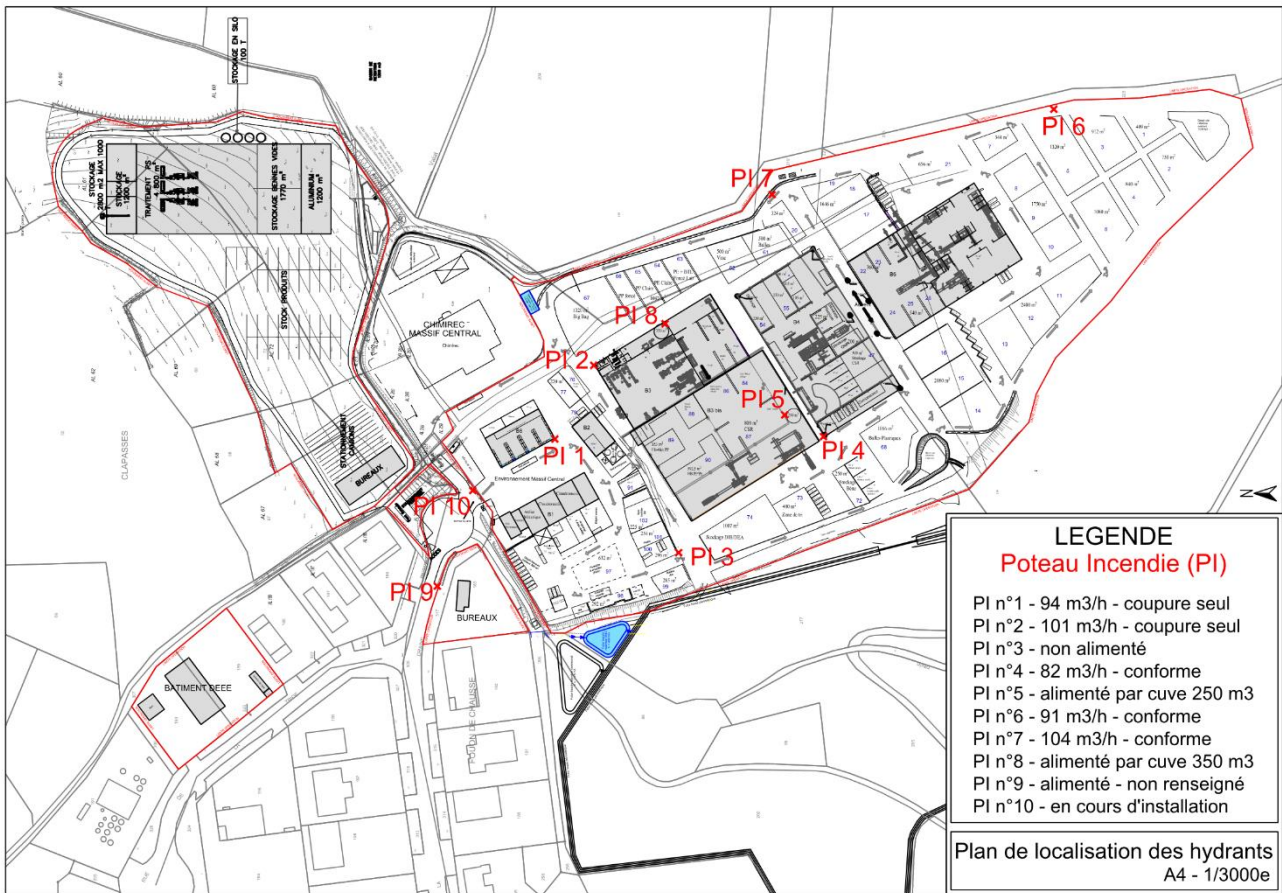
Plan de localisation des hydrants sur le site central d'Environnement Massif Central
